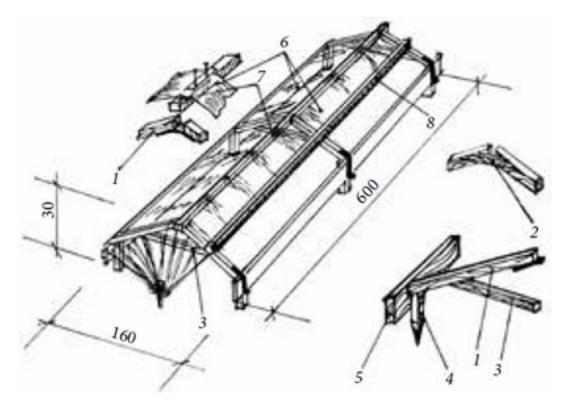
Разборно-переносной парник (размеры в см): 1 — стропильный брус; 2 — накладка; 3 — стяжка; 4 — колышек; 5 — бортовая доска; 6 — пленочное покрытие; 7 — коньковый брус; 8 — бобина
